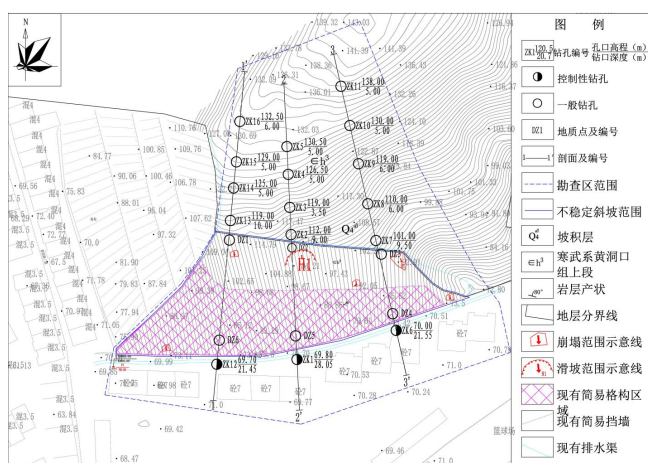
梧州市长洲区西环路上段23号北侧滑坡勘查平面图
